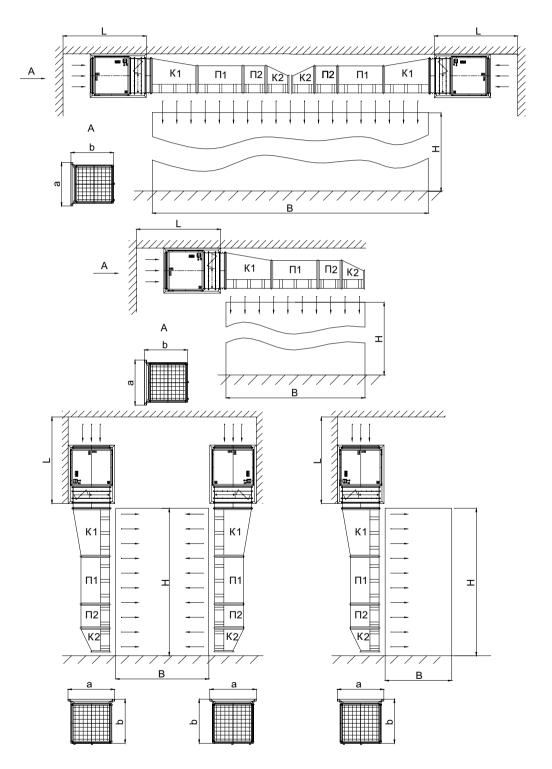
Габаритные размеры, необходимые для размещения стандартных завес с «линейным» силовым блоком
